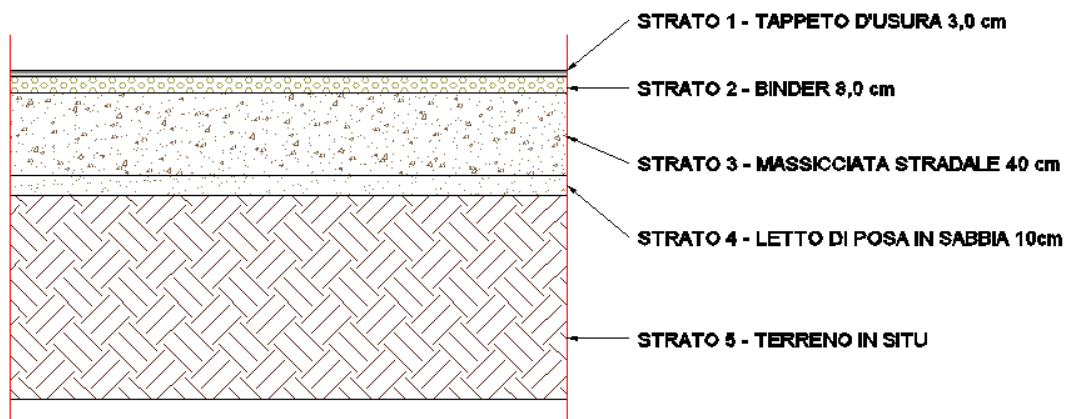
particolare costruttivo pavimentazione piazzali e aree di manovra – ES.EST.001 - Planimetria e particolari pavimentazione aree esterne
